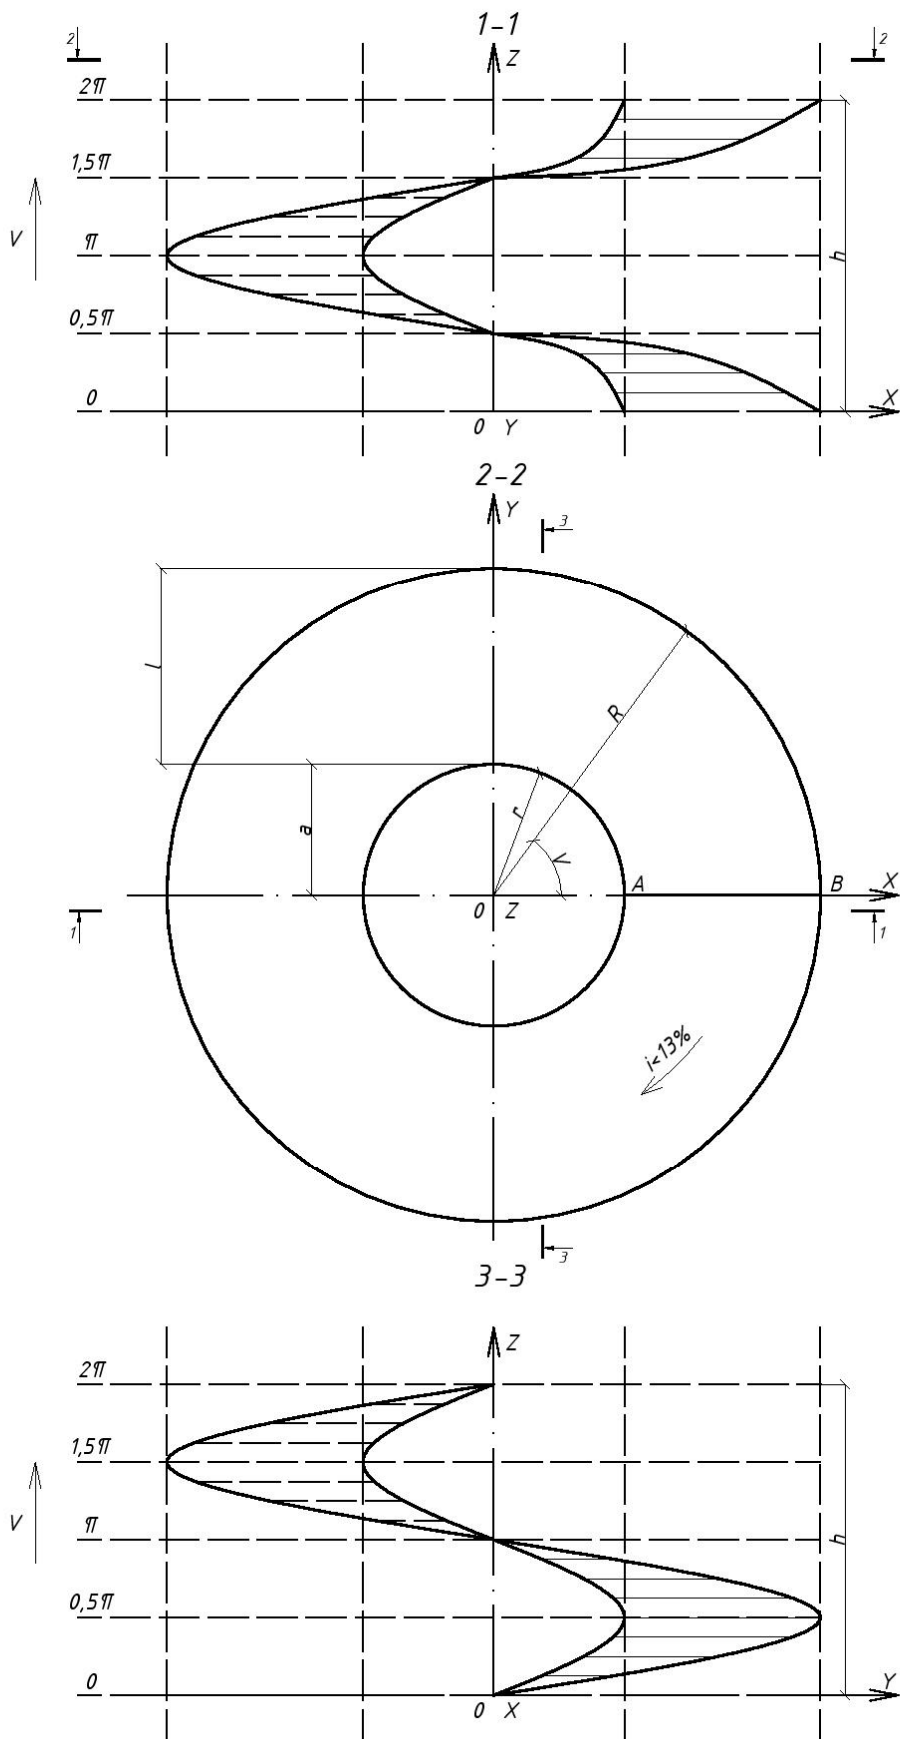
Схема утворення кругового пандуса як перекриття рампи без поперечного ухилу: 1-1 – фронтальний вигляд; 2-2 – план; 3-3 – боковий вигляд;  $AB$  – формоутворювальна горизонтальна пряма
